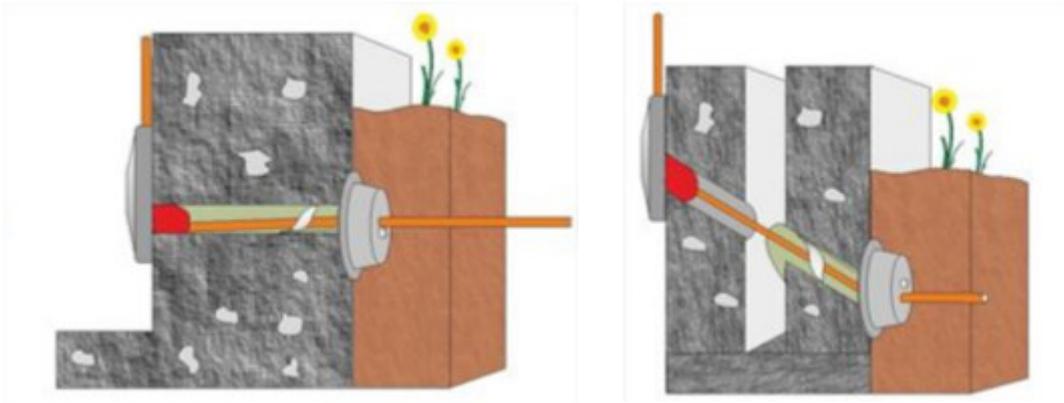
Mauerdurchführung MD1 ist für gerade und schräge Durchführungen geeignetBild 32 – Einzel-Mauerdurchführung (außen)Bild 33– Mehrfachmauerdurchführung (außen)
